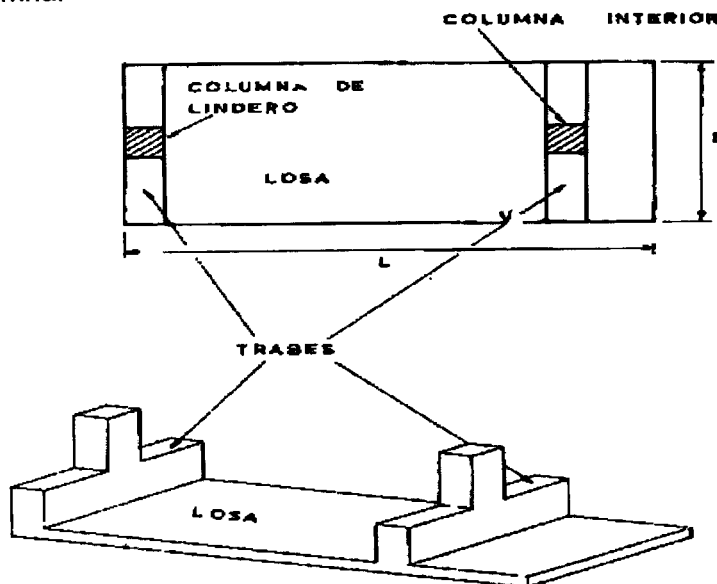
Zapata Combinada(por medio de traveses transversales sobre la losa).
